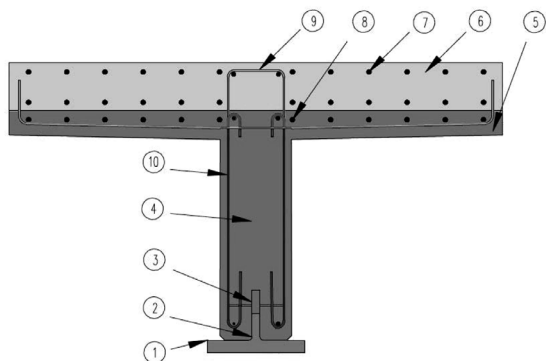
Элементы сталежелезобетонного сечения с соединением «на зубцах»:
